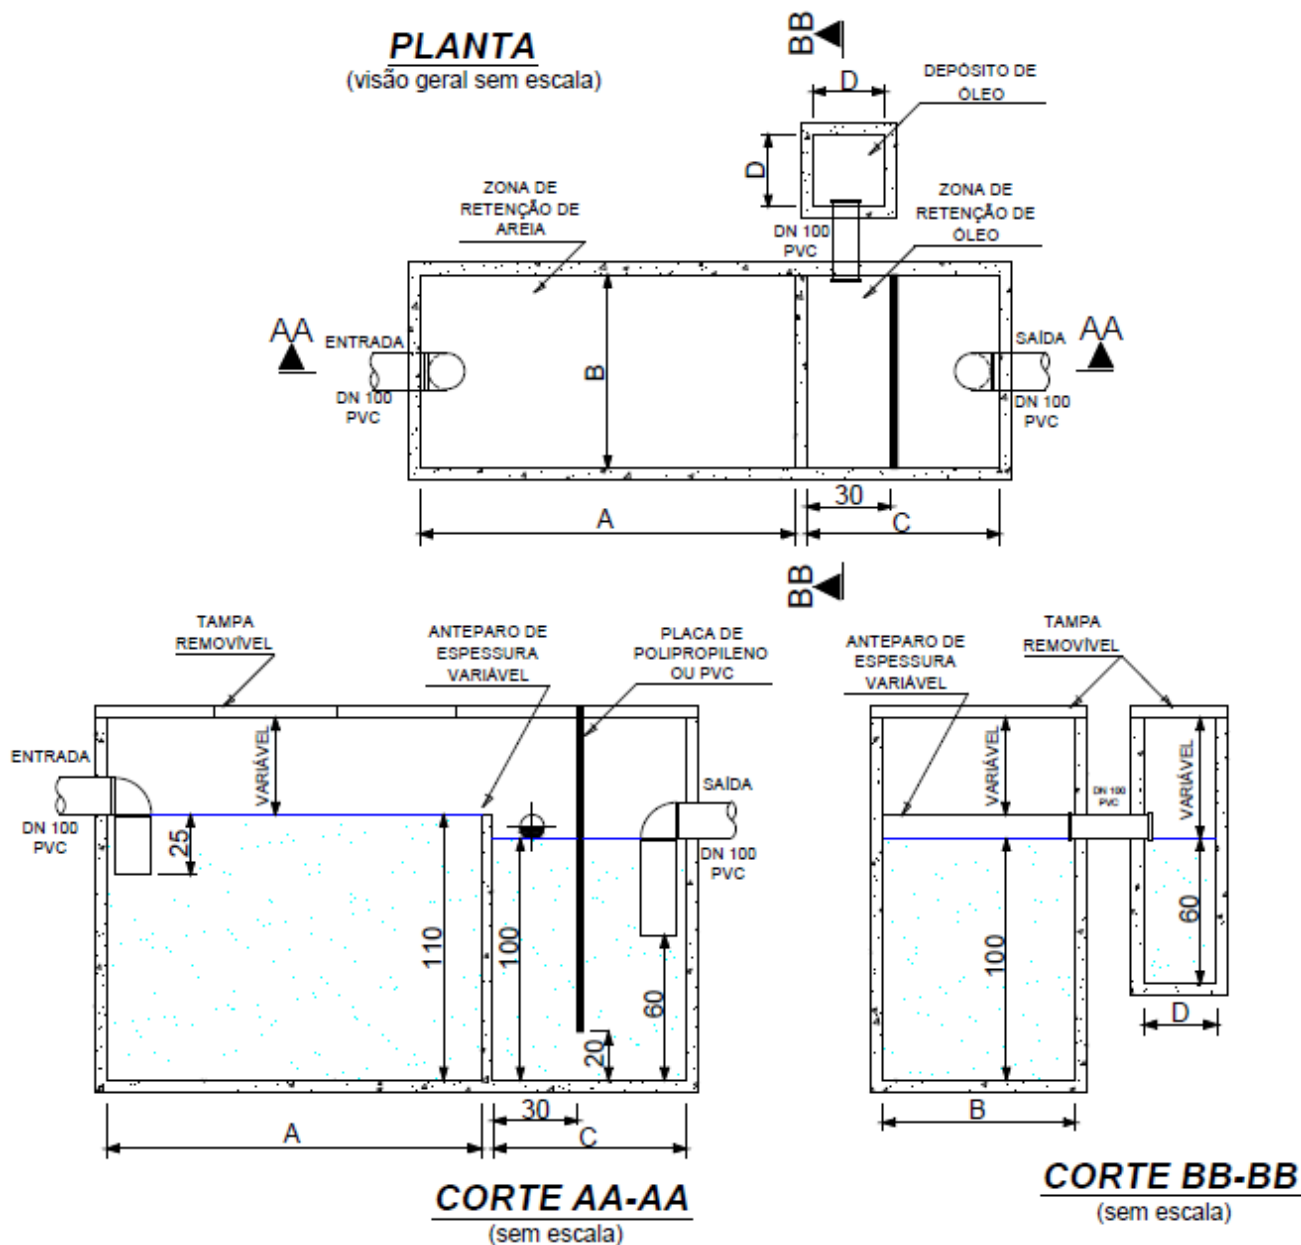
Planta da Caixa de Retenção de Óleo e Areia
